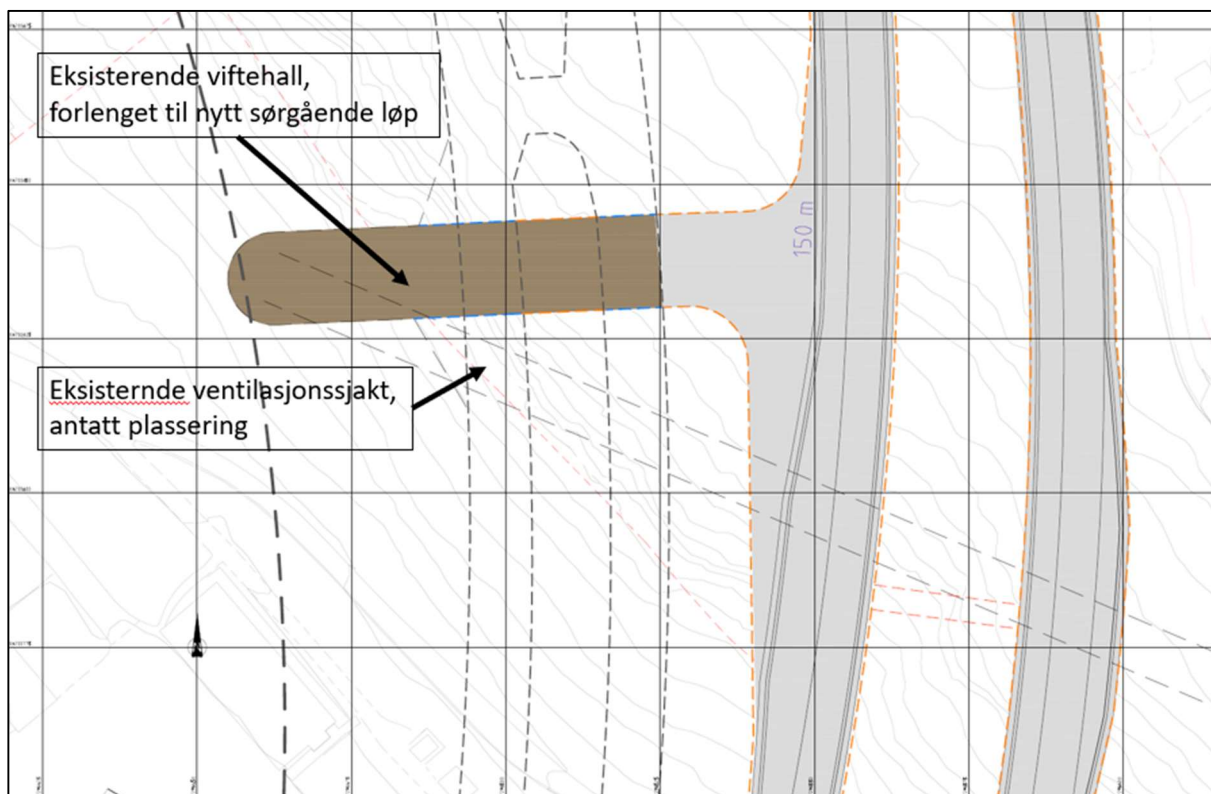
Plantegning av eksisterende ventilasjonstårn tilknyttet sydgående tunnellop.
